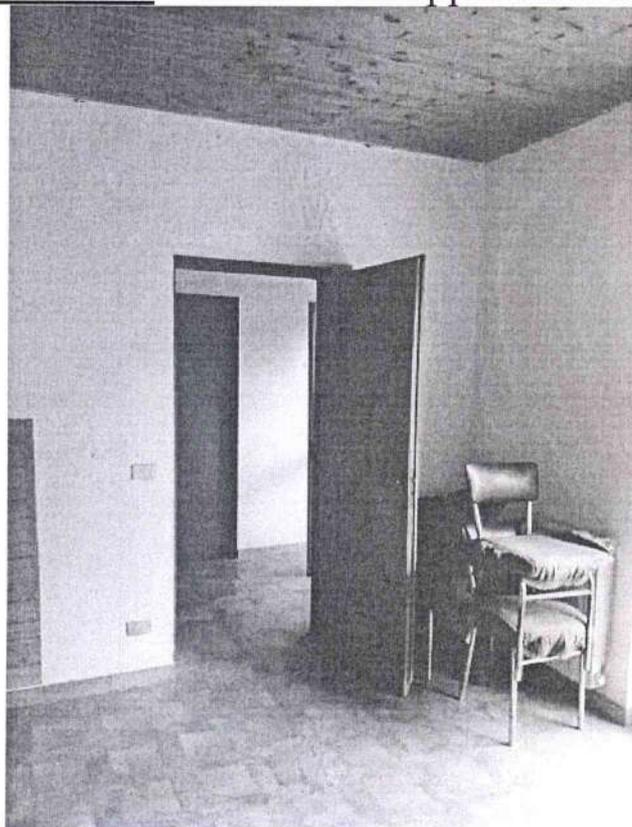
Particolare del pavimento, degli infissi e del balcone
